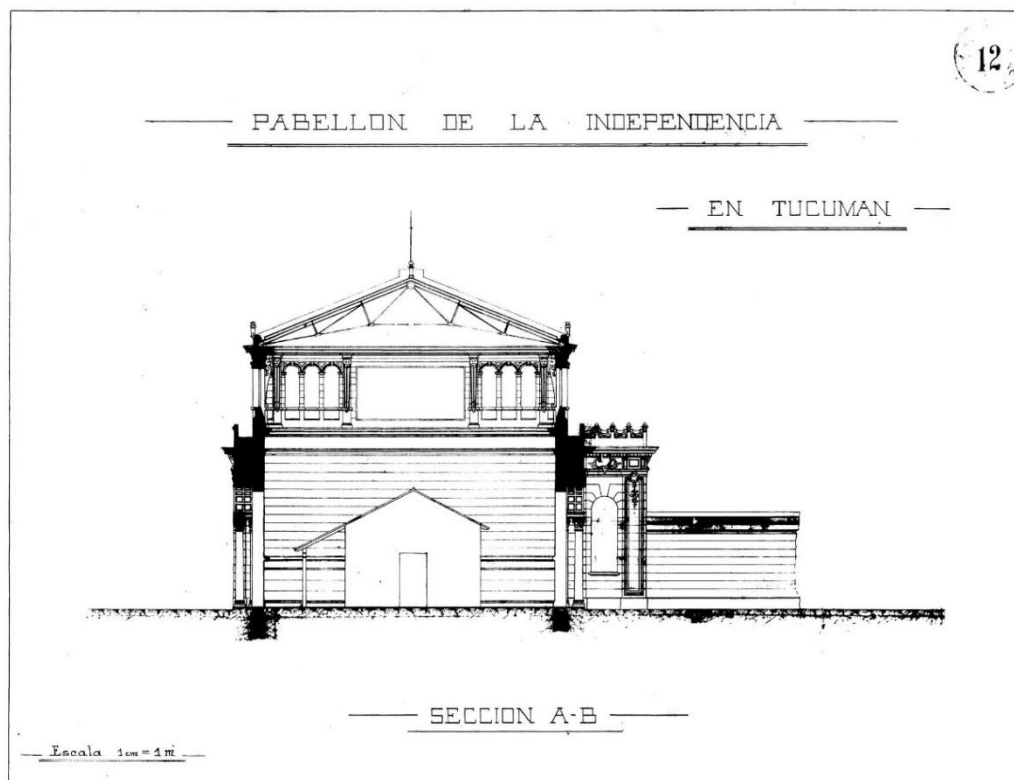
Corte Vista del proyecto definitivo Plano N° 12 DNOA
